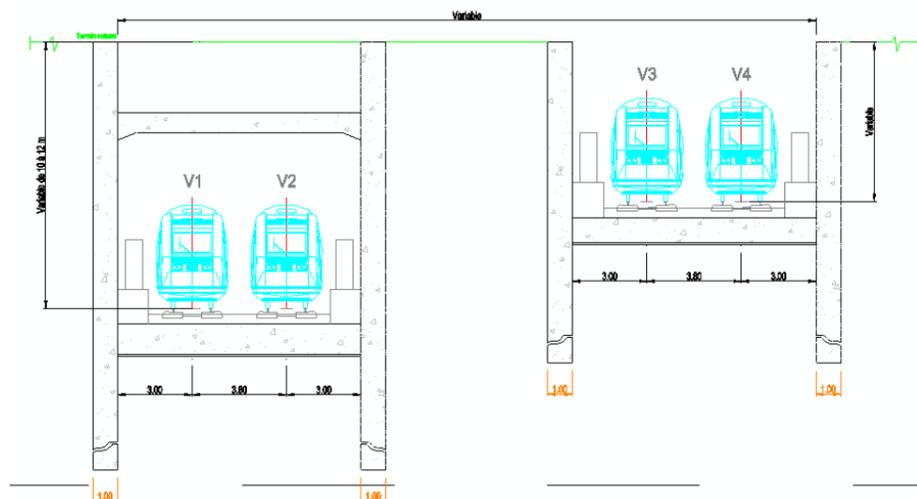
Coupe GC de la section en TC et TO lorsque la voie SNCF remonte au sud de Lesquin (Coupe C-C)
